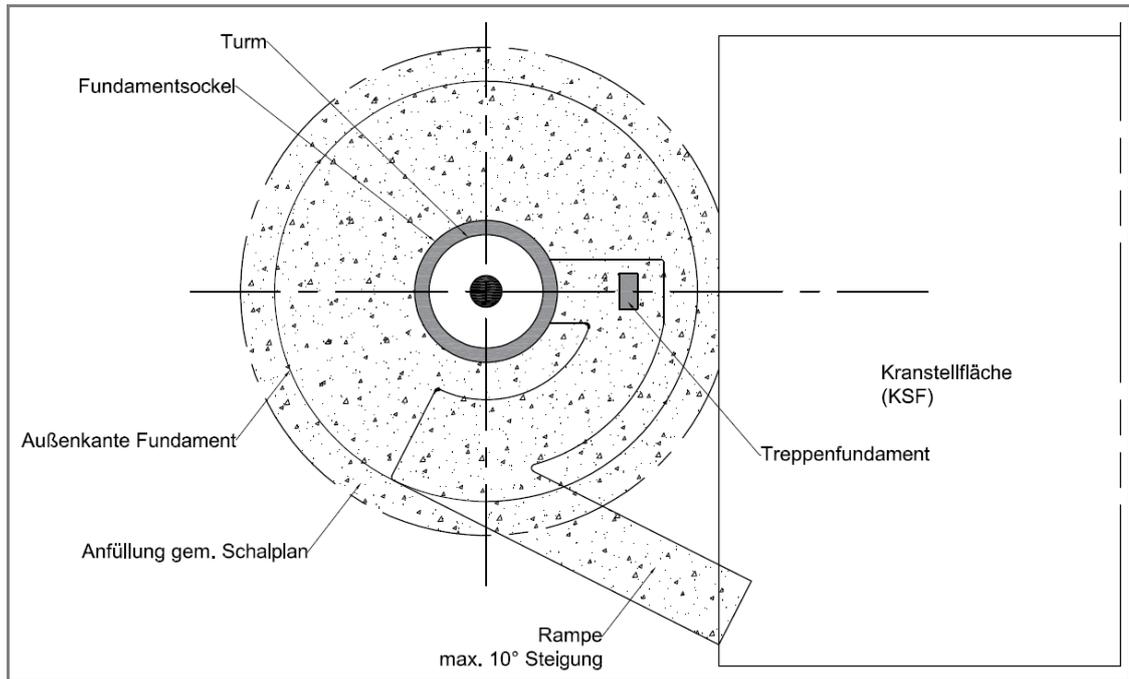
Fläche um den Turm in Draufsicht, Stahlrohrturm ohne Außenflansch
